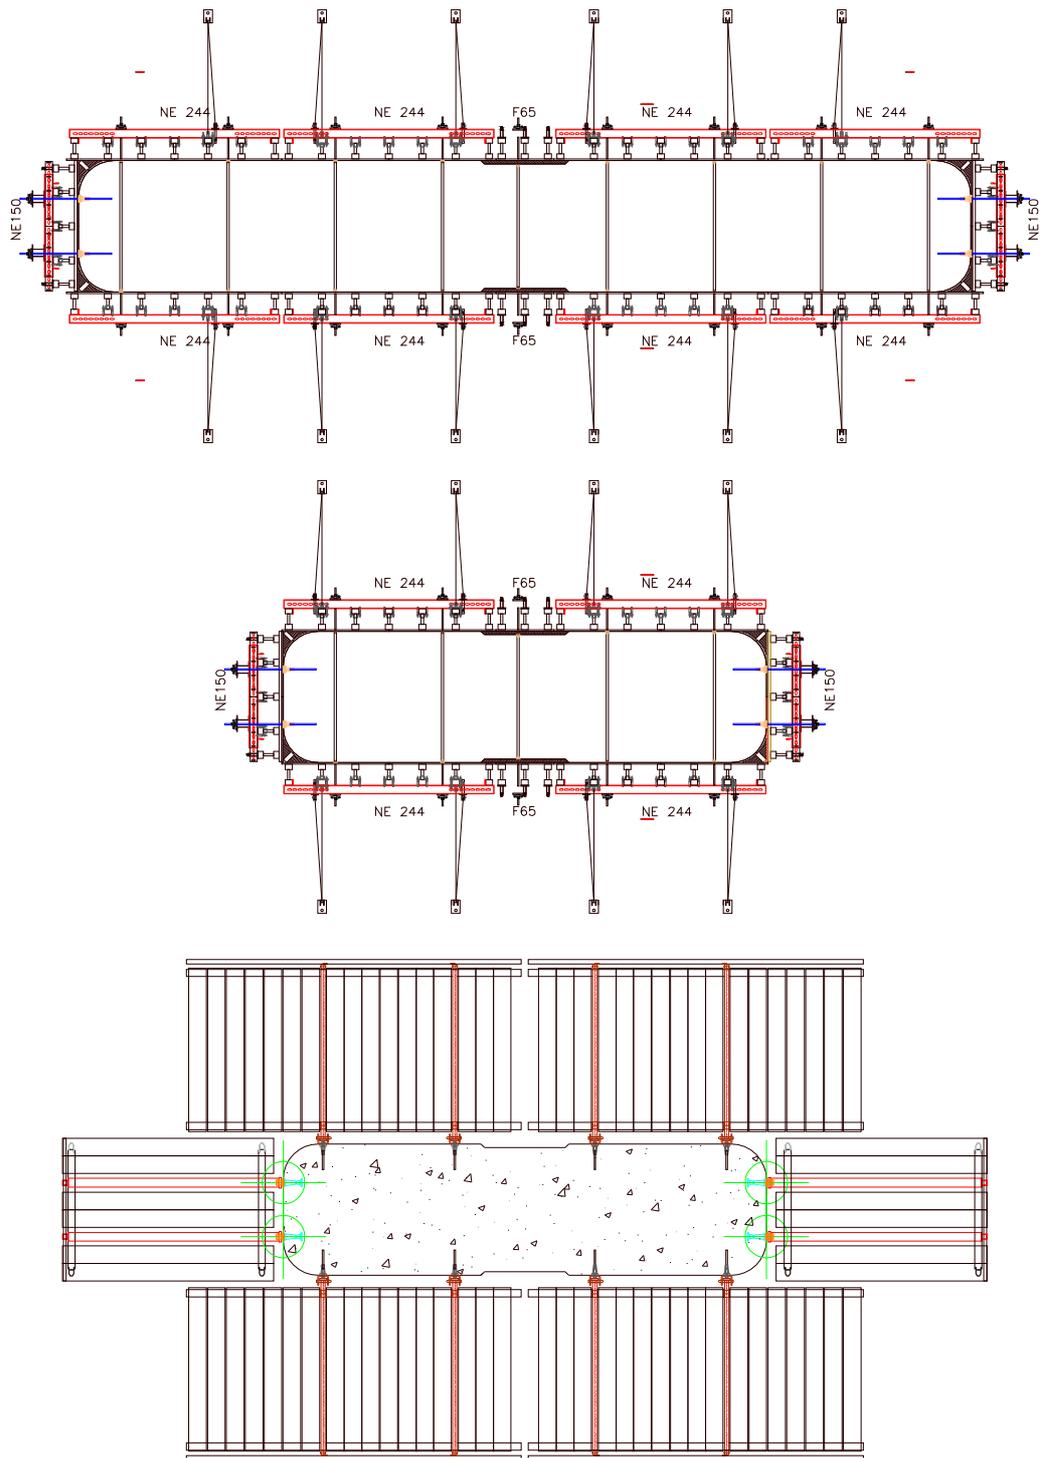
Tampak atas Formwork Pier Tahap 1
